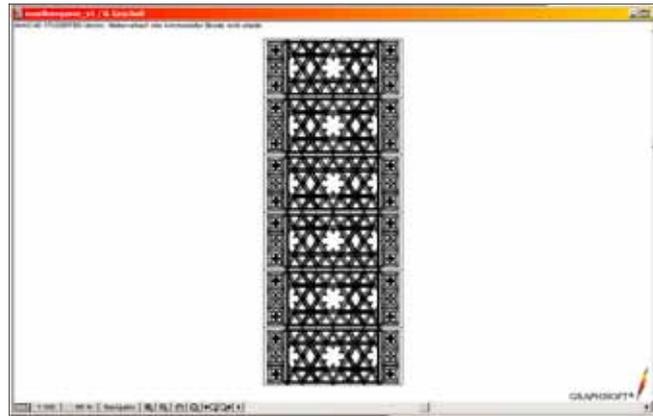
Grundrißdarstellung der Ebene: "Objekt 24_Decke"
